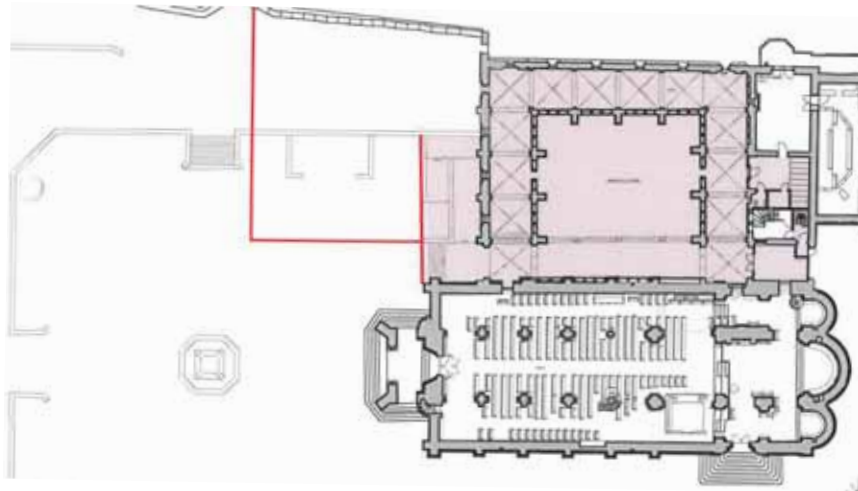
Mi 2014-fin 2016. En rouge, l'installation de chantier. En violet, les zones non accessibles
